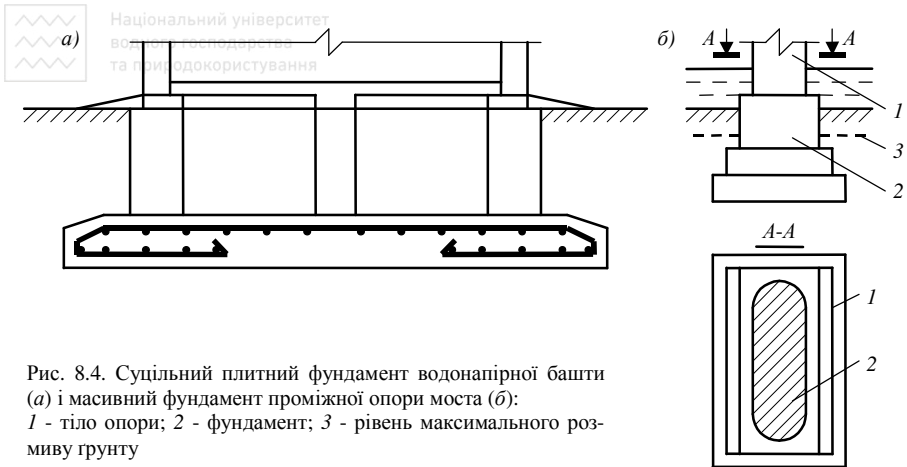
Суцільний плитний фундамент водонапірної башти (а) і масивний фундамент проміжної опори моста (б): 1 - тіло опори; 2 - фундамент; 3 - рівень максимального розмиву ґрунту
